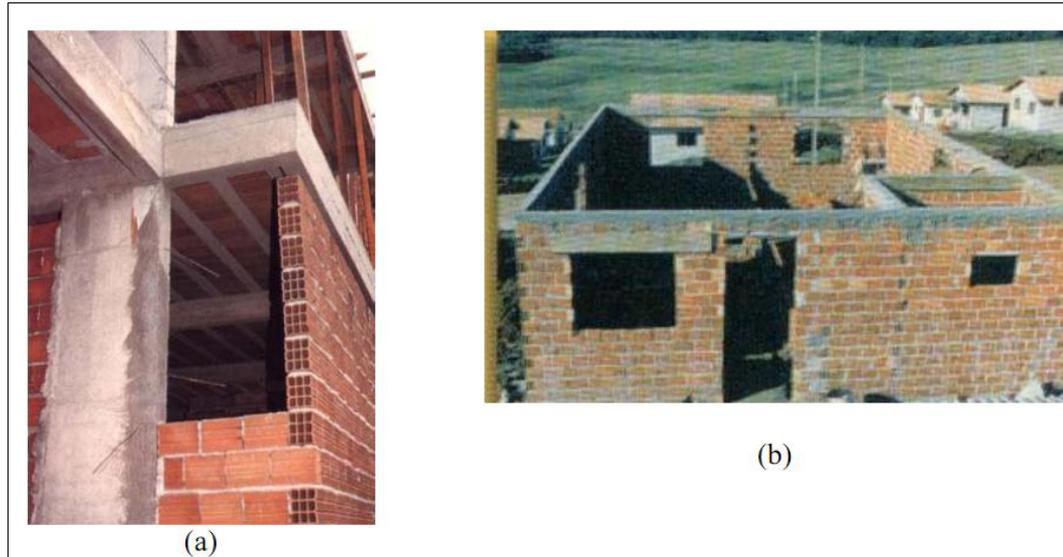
Execução de alvenaria após execução da estrutura (a) e antes da estrutura (b).
